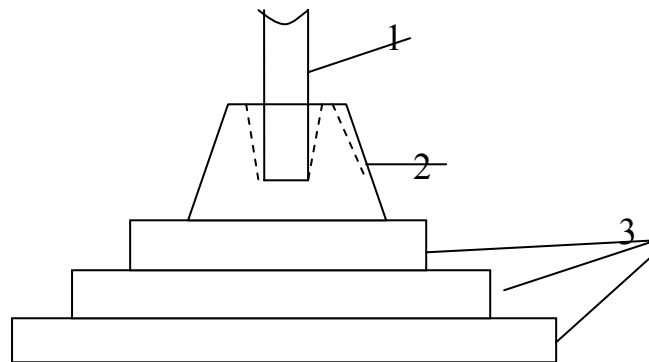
Збірний залізобетонний фундамент стаканного типу:
